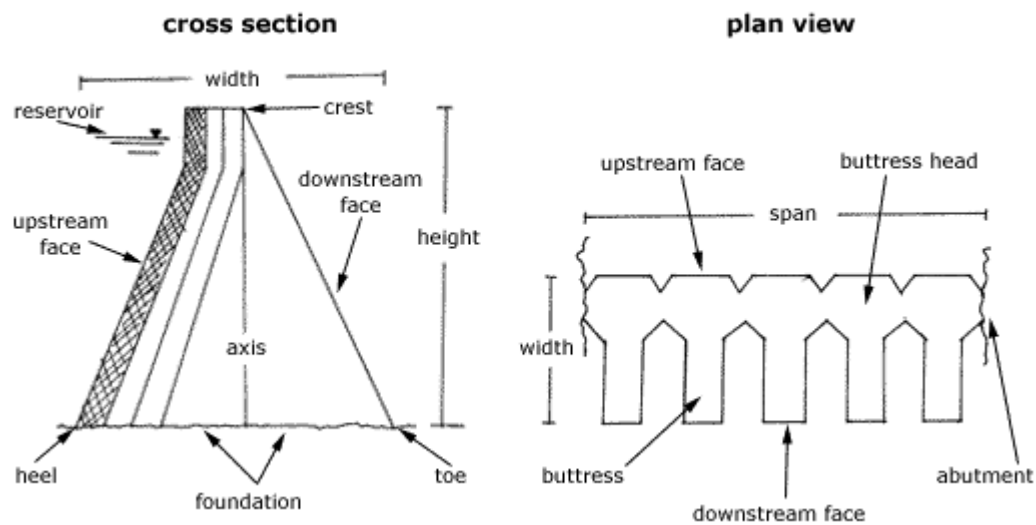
Seção e Planta de uma barragem gravidade com contrafortes [88]
